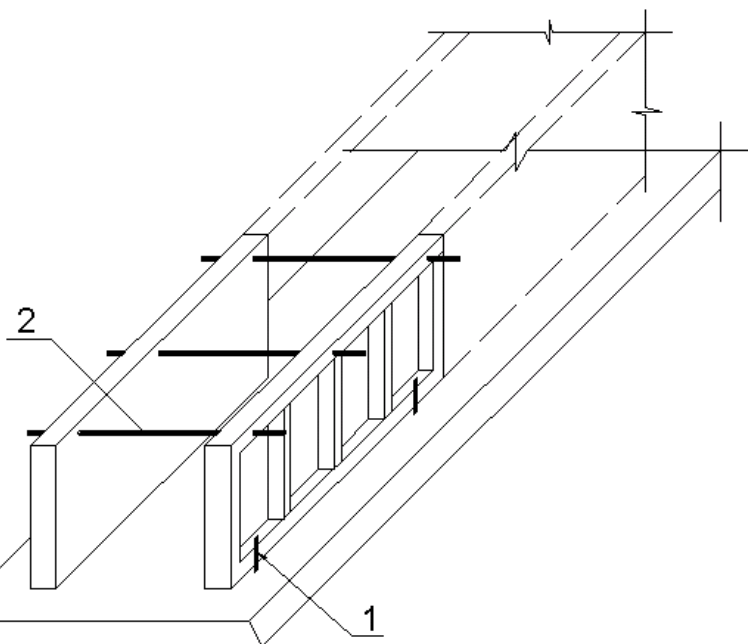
Анкеровка щитов опалубки: 1 – анкер (арматура ф 12, L=250-300мм); 2 – Тяж.
